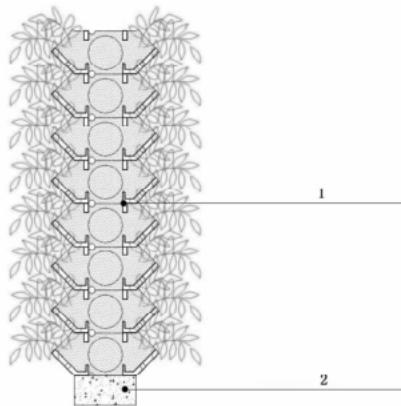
7.2 预制自承重混凝土构件(双面)垂直绿化示意图
